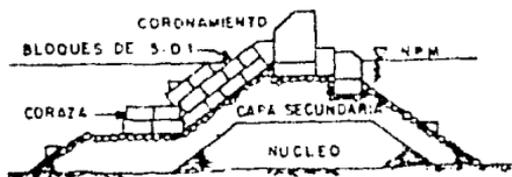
Rompeolas de enrocamiento y bloques de concreto.
